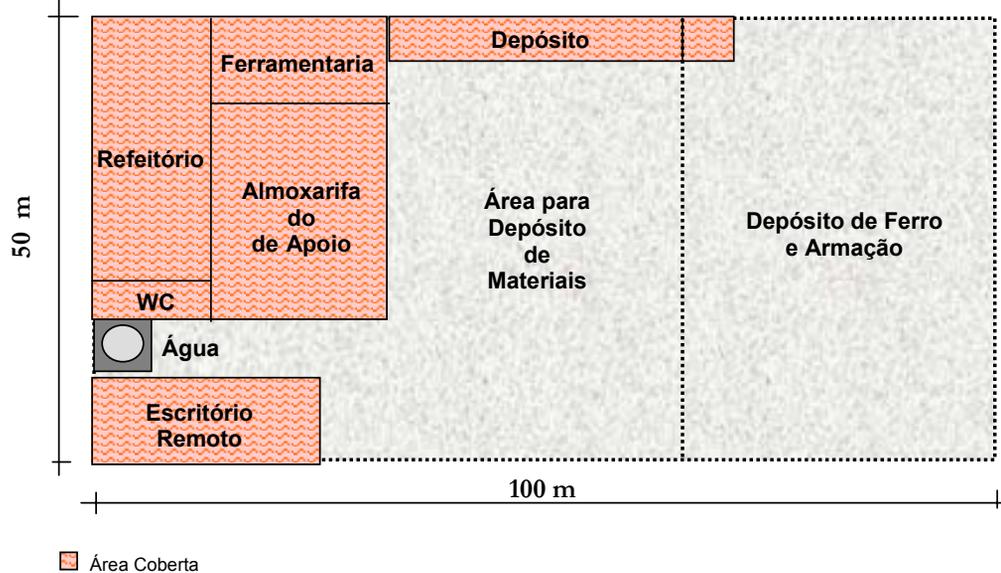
Estrutura básica do canteiro de apoio.
